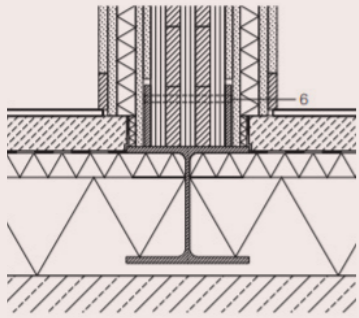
Rautihuss-Anschlussdetail Stahlträger-Massivholzwand
